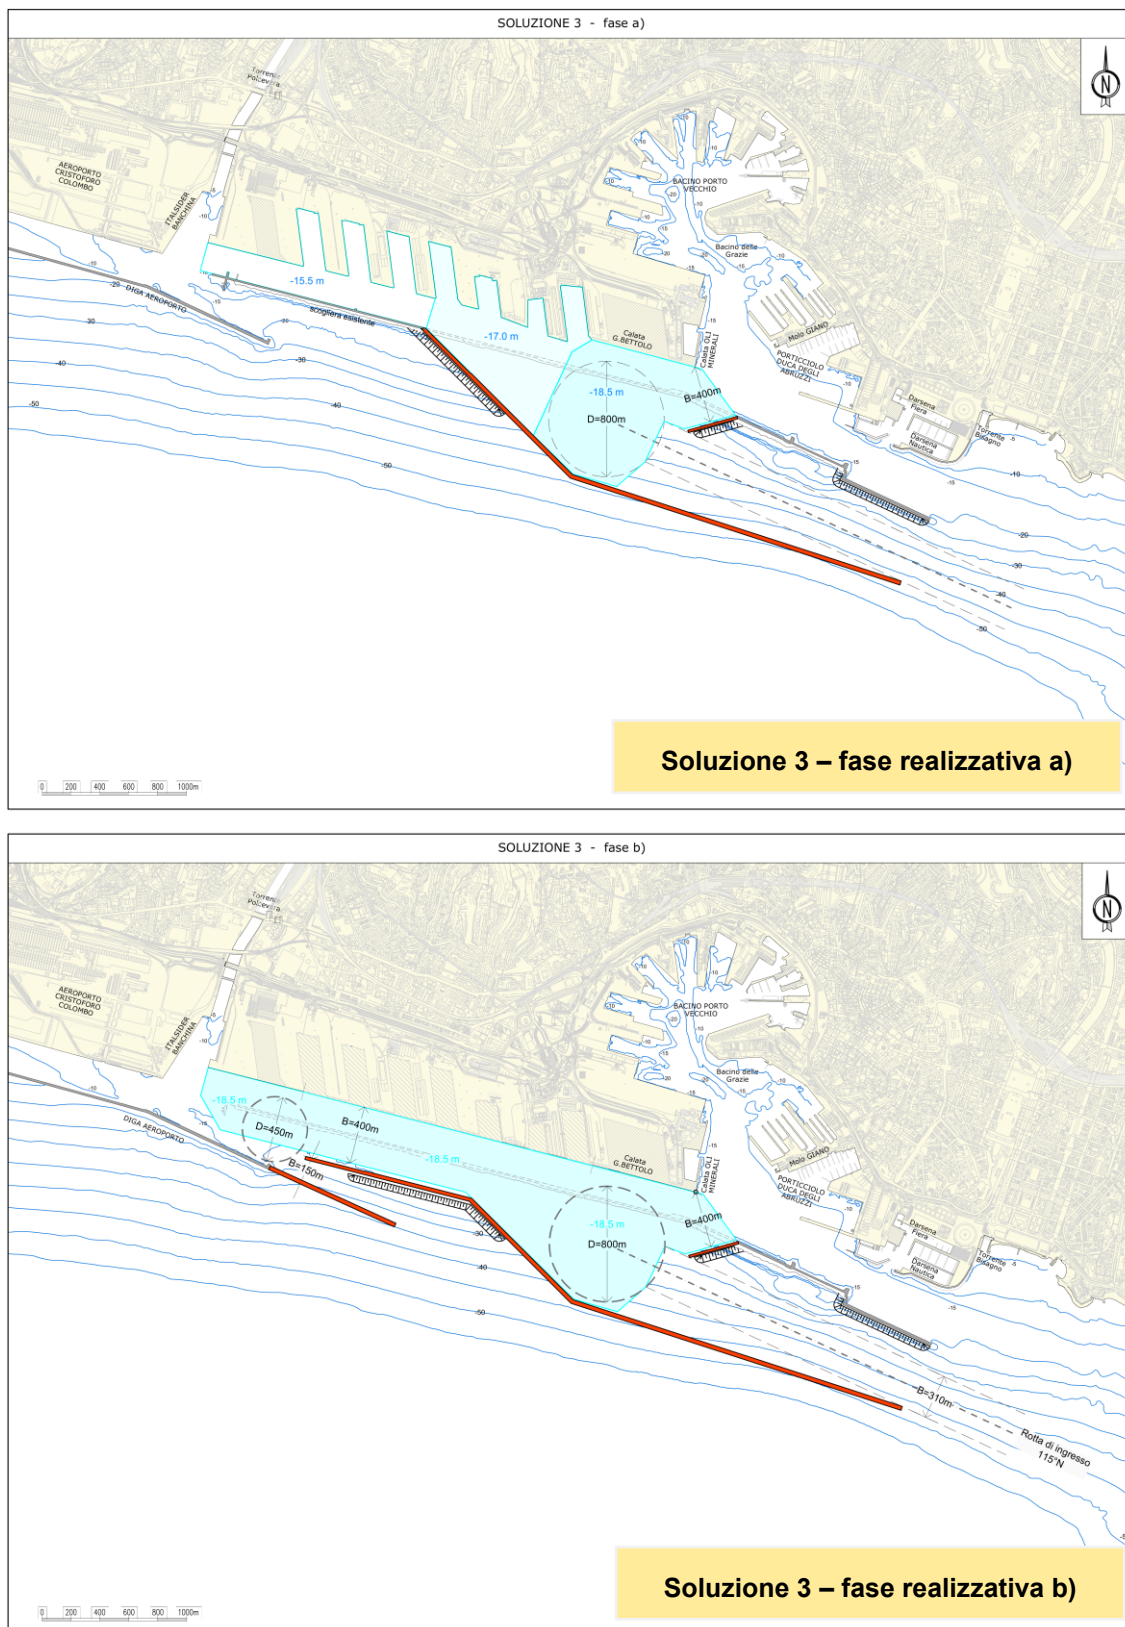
CONFIGURAZIONE PLANIMETRICA DELLA SOLUZIONE 3 - FASE A) E FASE B).
